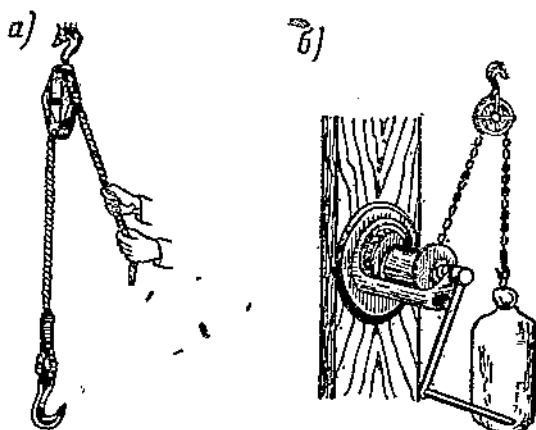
Подъемные приспособления: а — блок; б — лебедка
